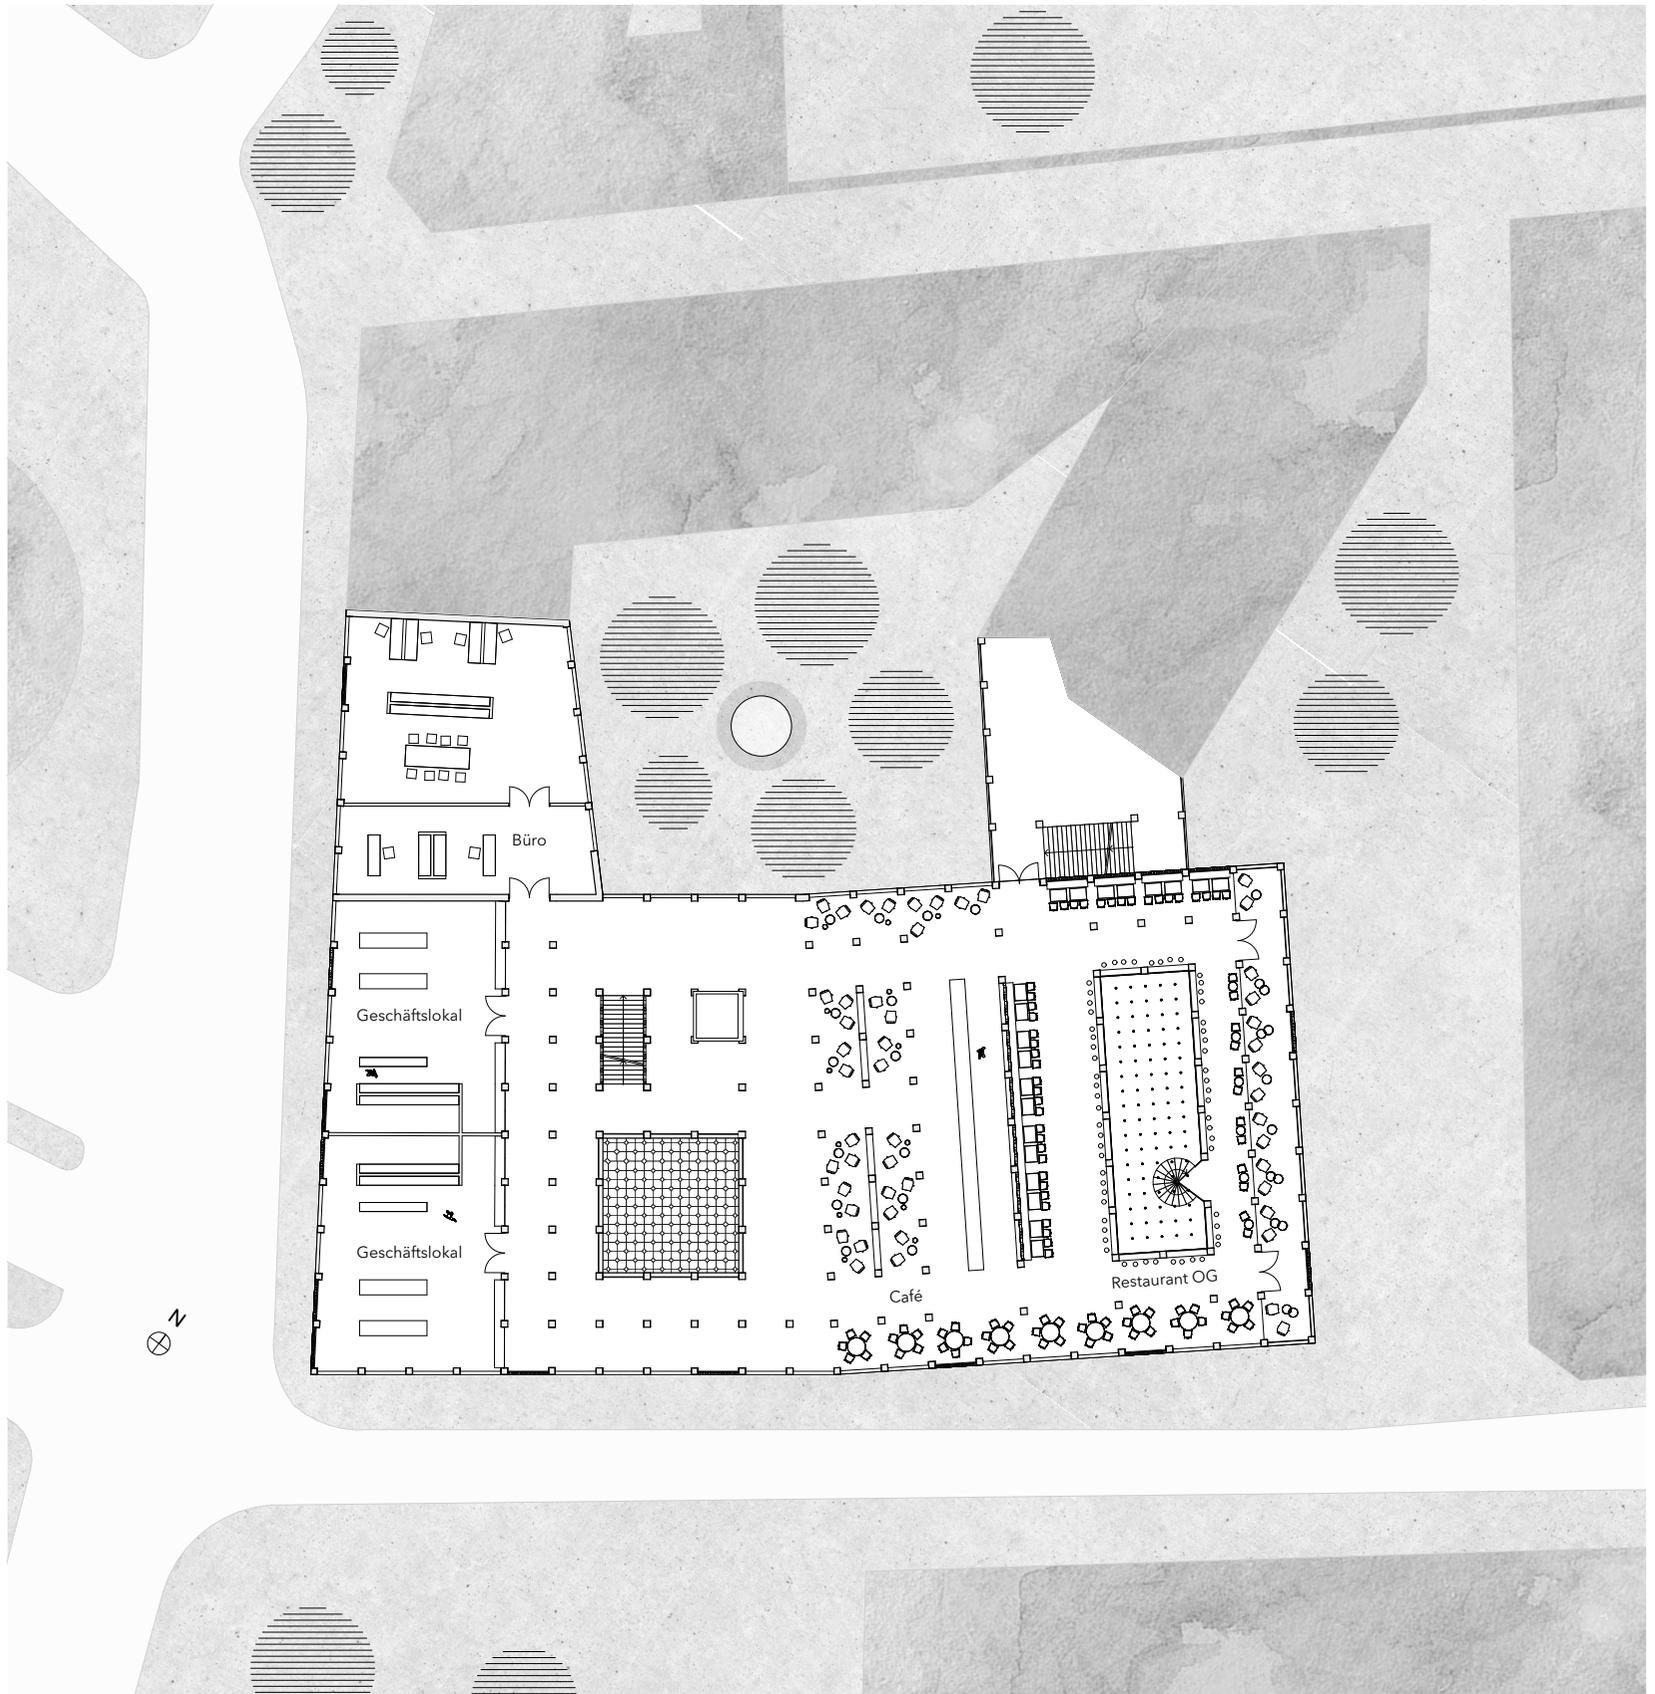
Grundriss Ebene 1 | 1:500
